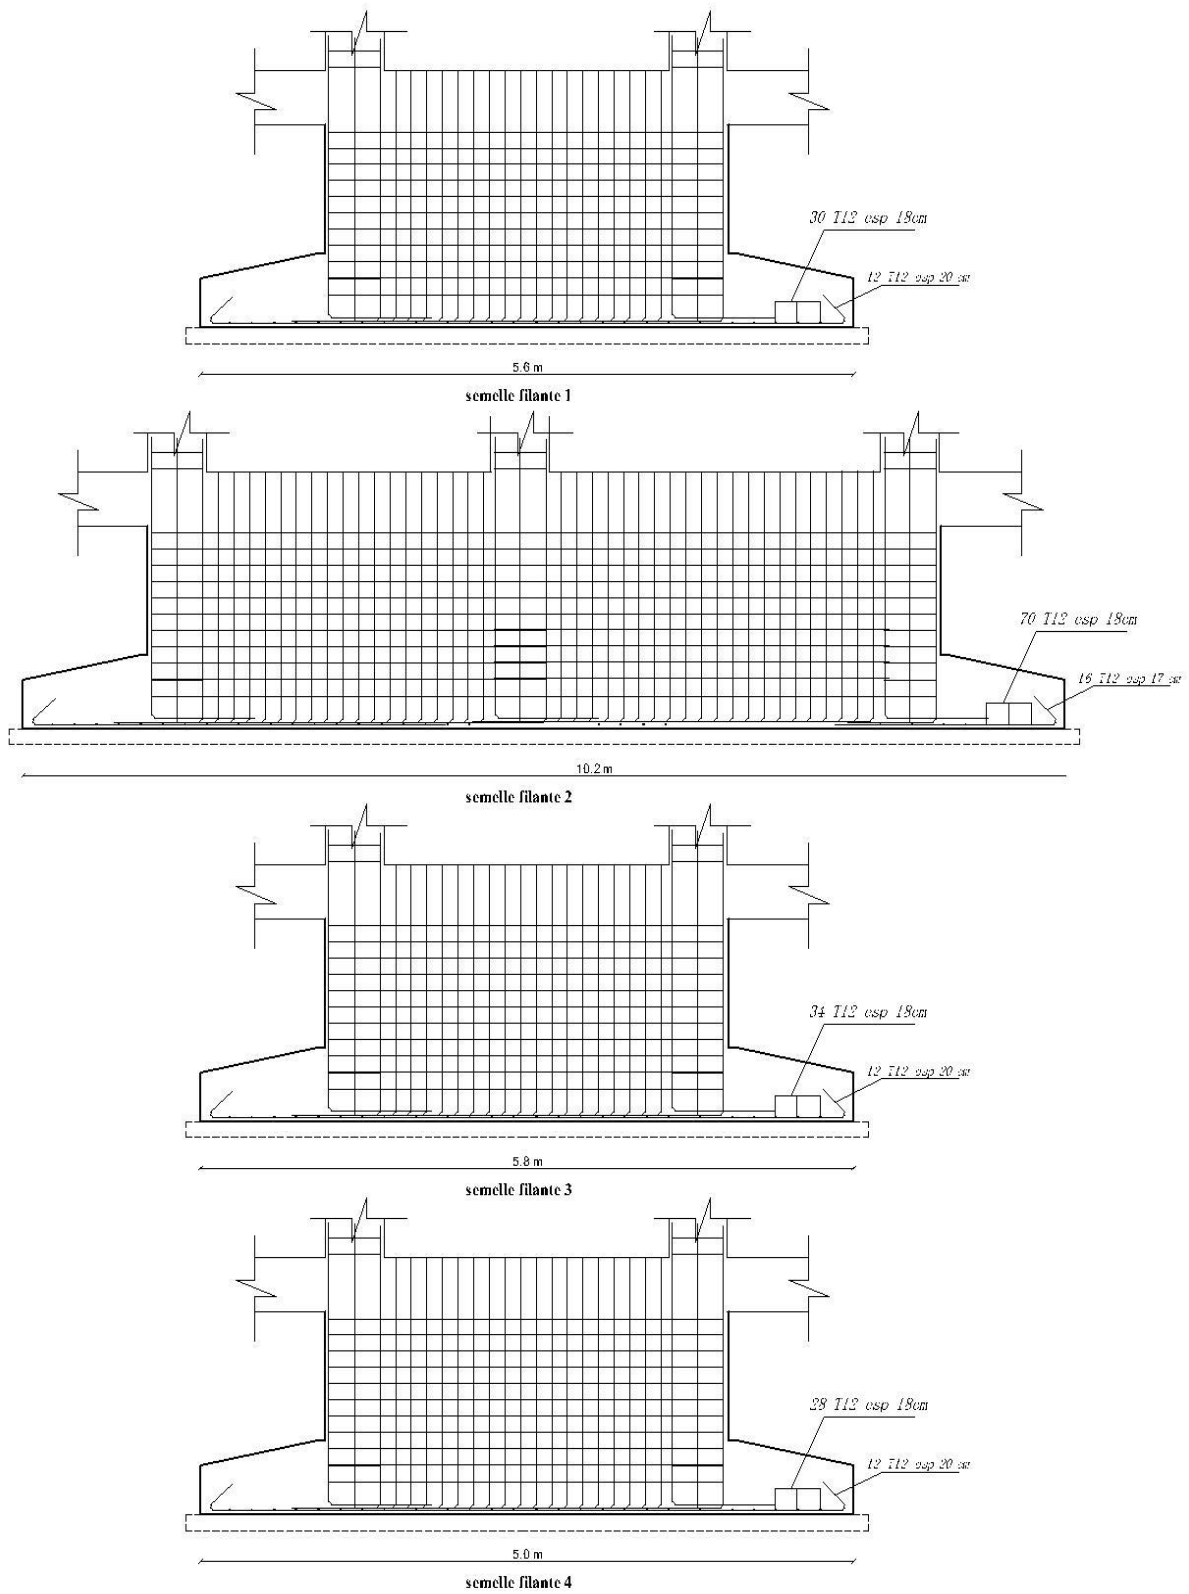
ferrailage de semelles filantes 1, 2, 3 et 4
